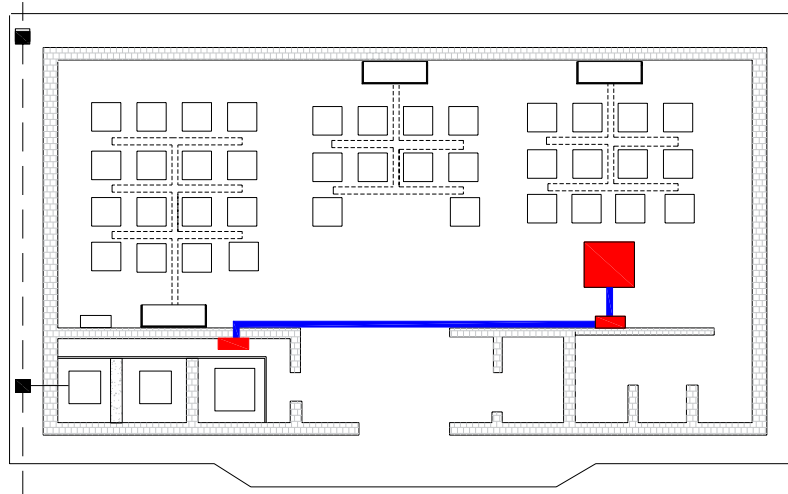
Planta baixa de uma indústria atendida em média tensão.
